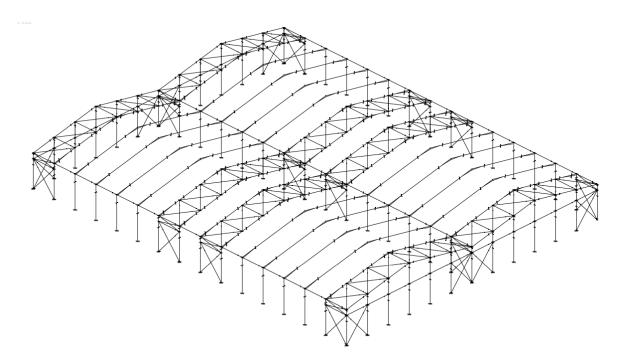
Estructura metálica de la nave (CYPE 3D).
